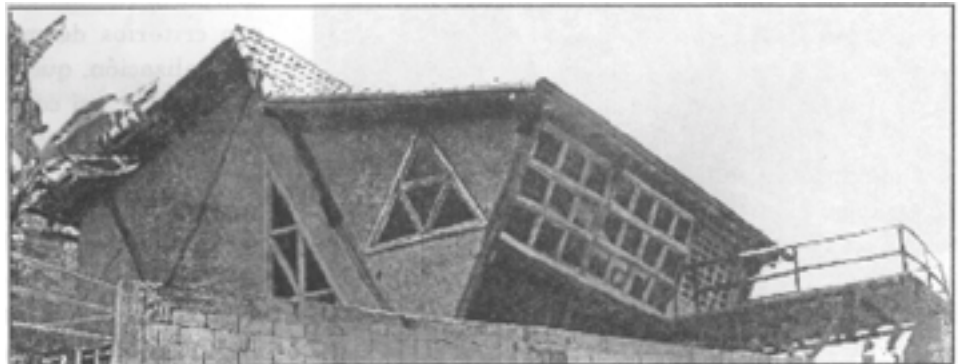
Vista fachada principal de la vivienda rural moderna Mucuntán - I.
